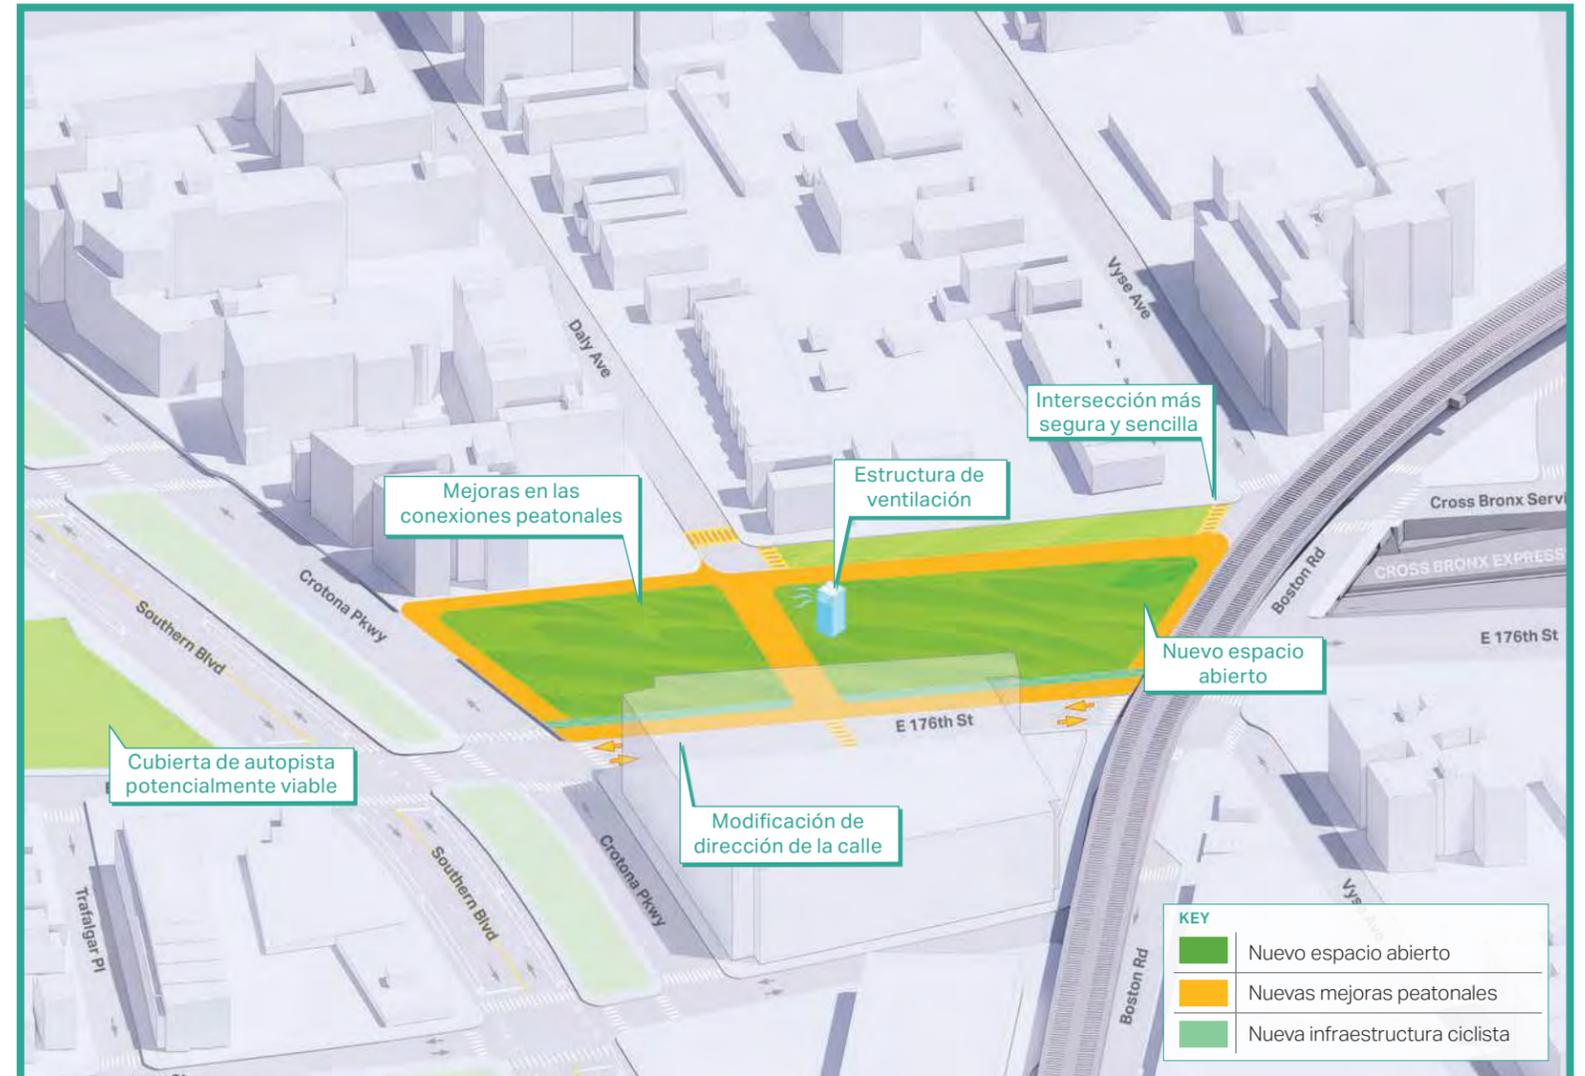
Concepto potencial de cubierta de autopista entre Crotona Parkway y Boston Road
